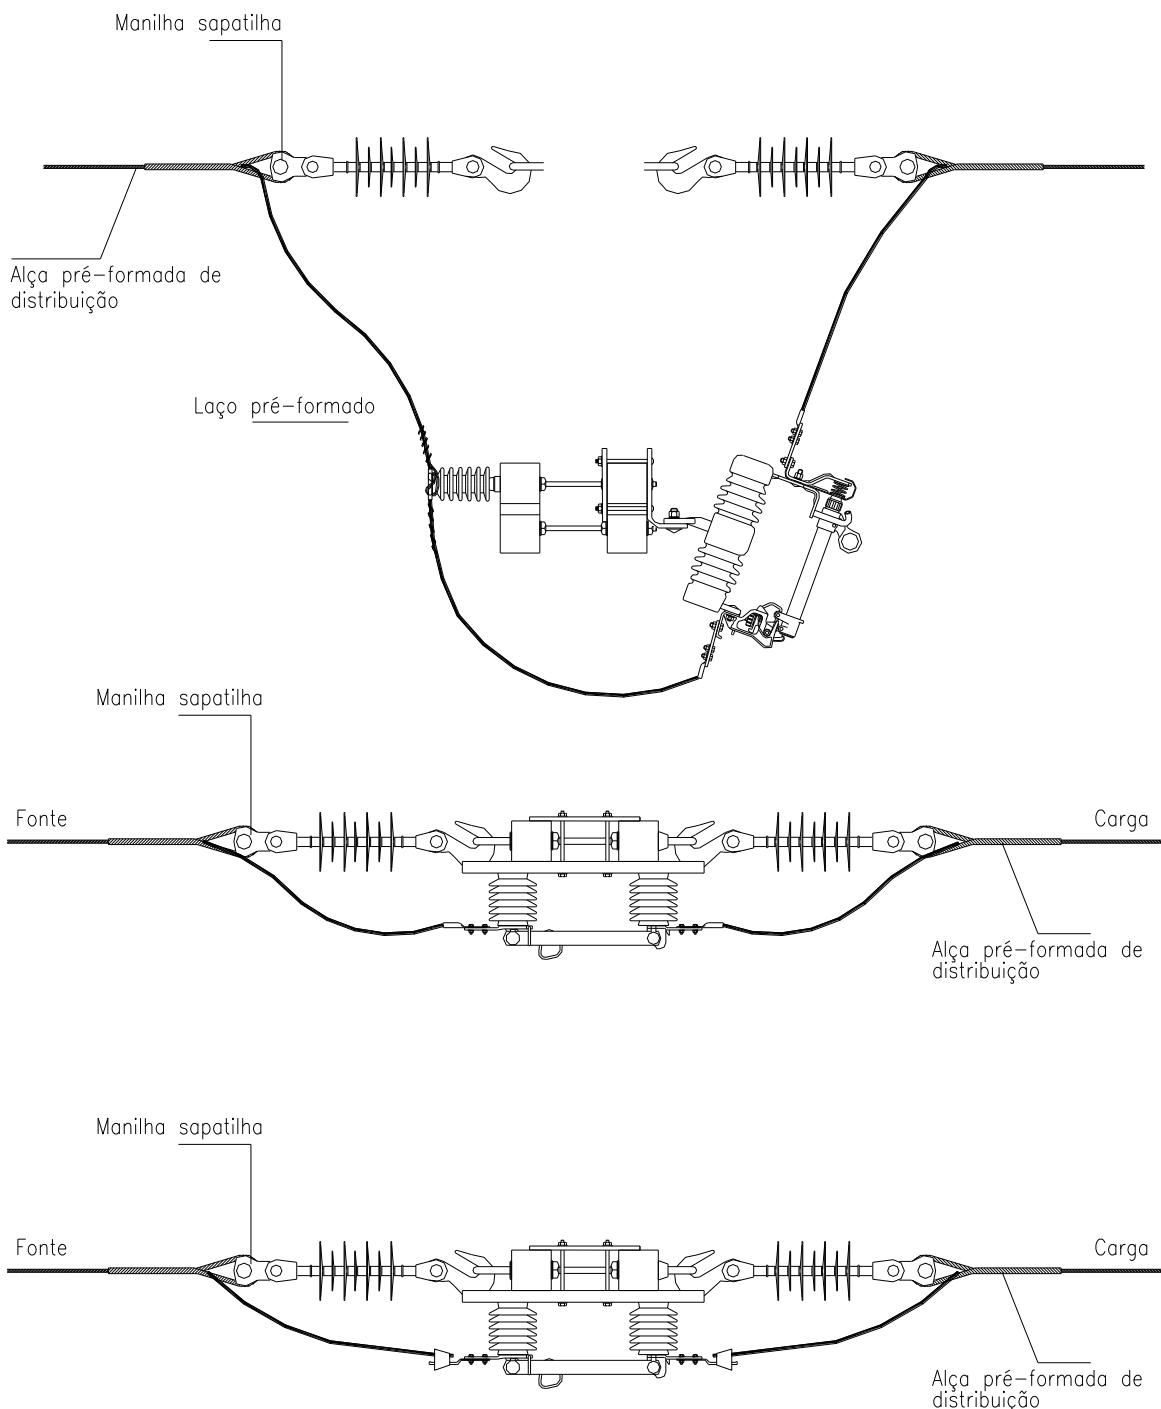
Amarrações e ligações – Primário – Chave-fusível e faca ao longo da rede
